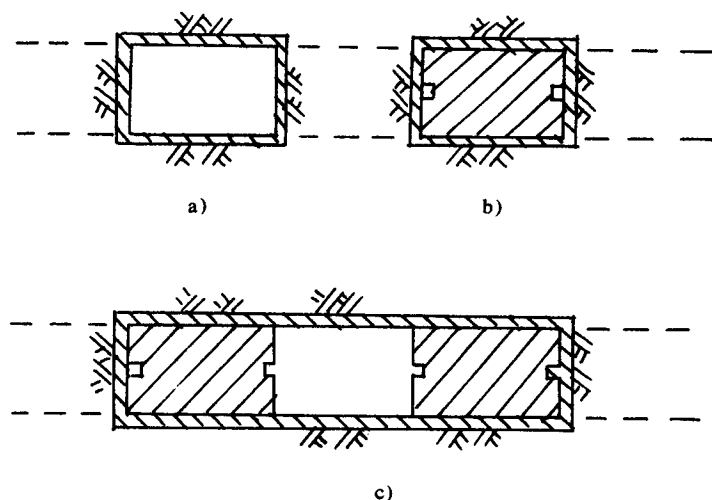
挖孔排桩地下连续墙施工平面简图
